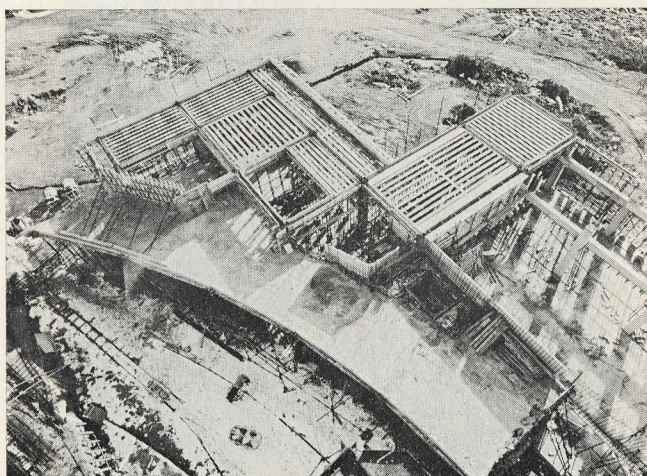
État du chantier fin campagne 1962 : le bétonnage du plancher haut du rez-de-chaussée n'est pas commencé — Seule la première galerie Nord est partiellement réalisée sur le quart de sa longueur.
